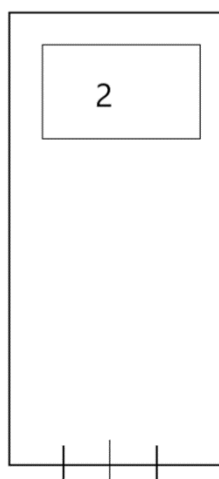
План размещения пожарной нагрузки в электрощитовой
